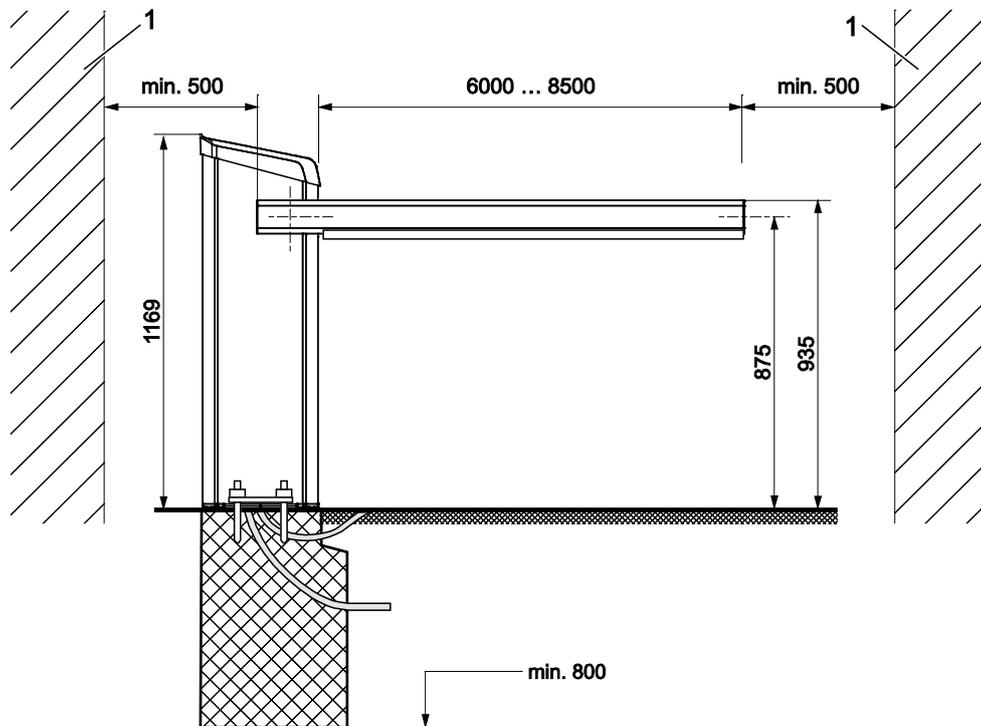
Abmessungen Schrankenanlage und Schrankenbaumprofil – Serie "Access XL" (Maße in mm)
